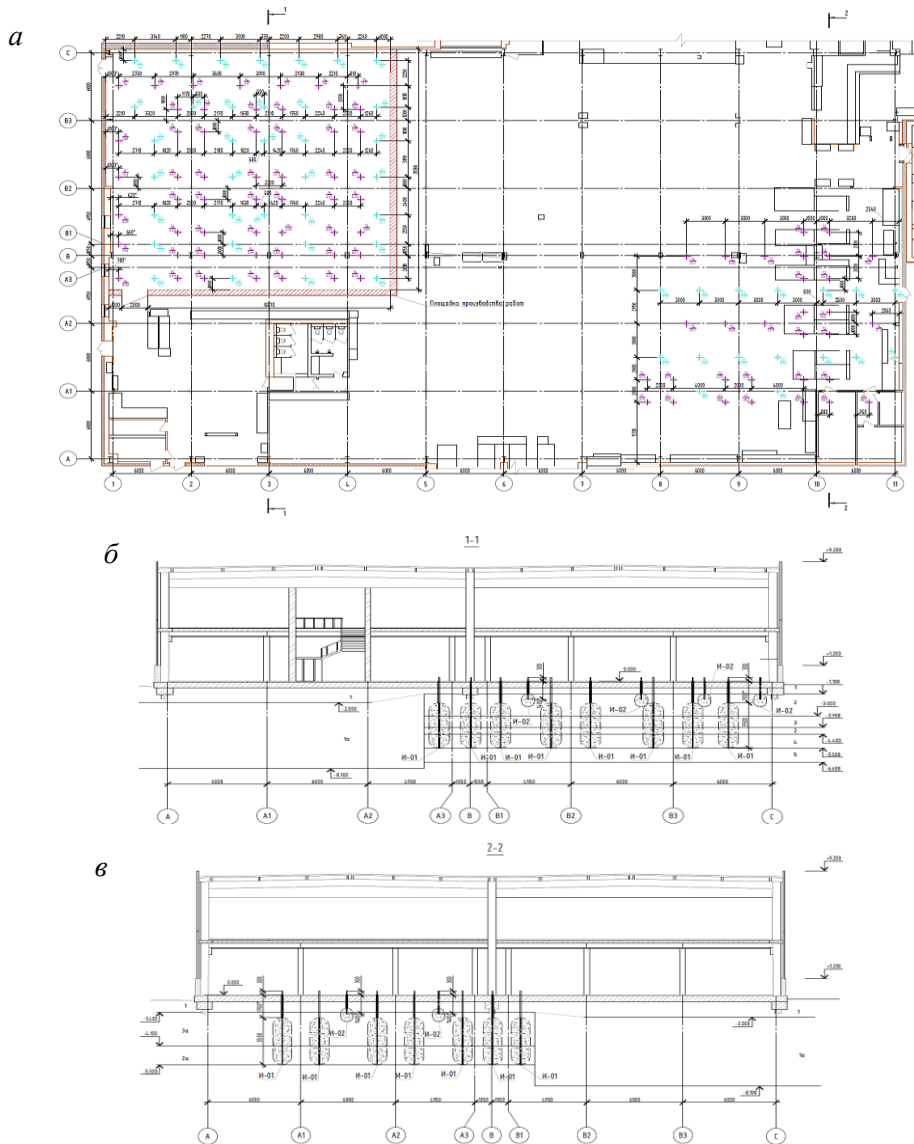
План (а) и схемы уплотнения грунтового основания (б)
